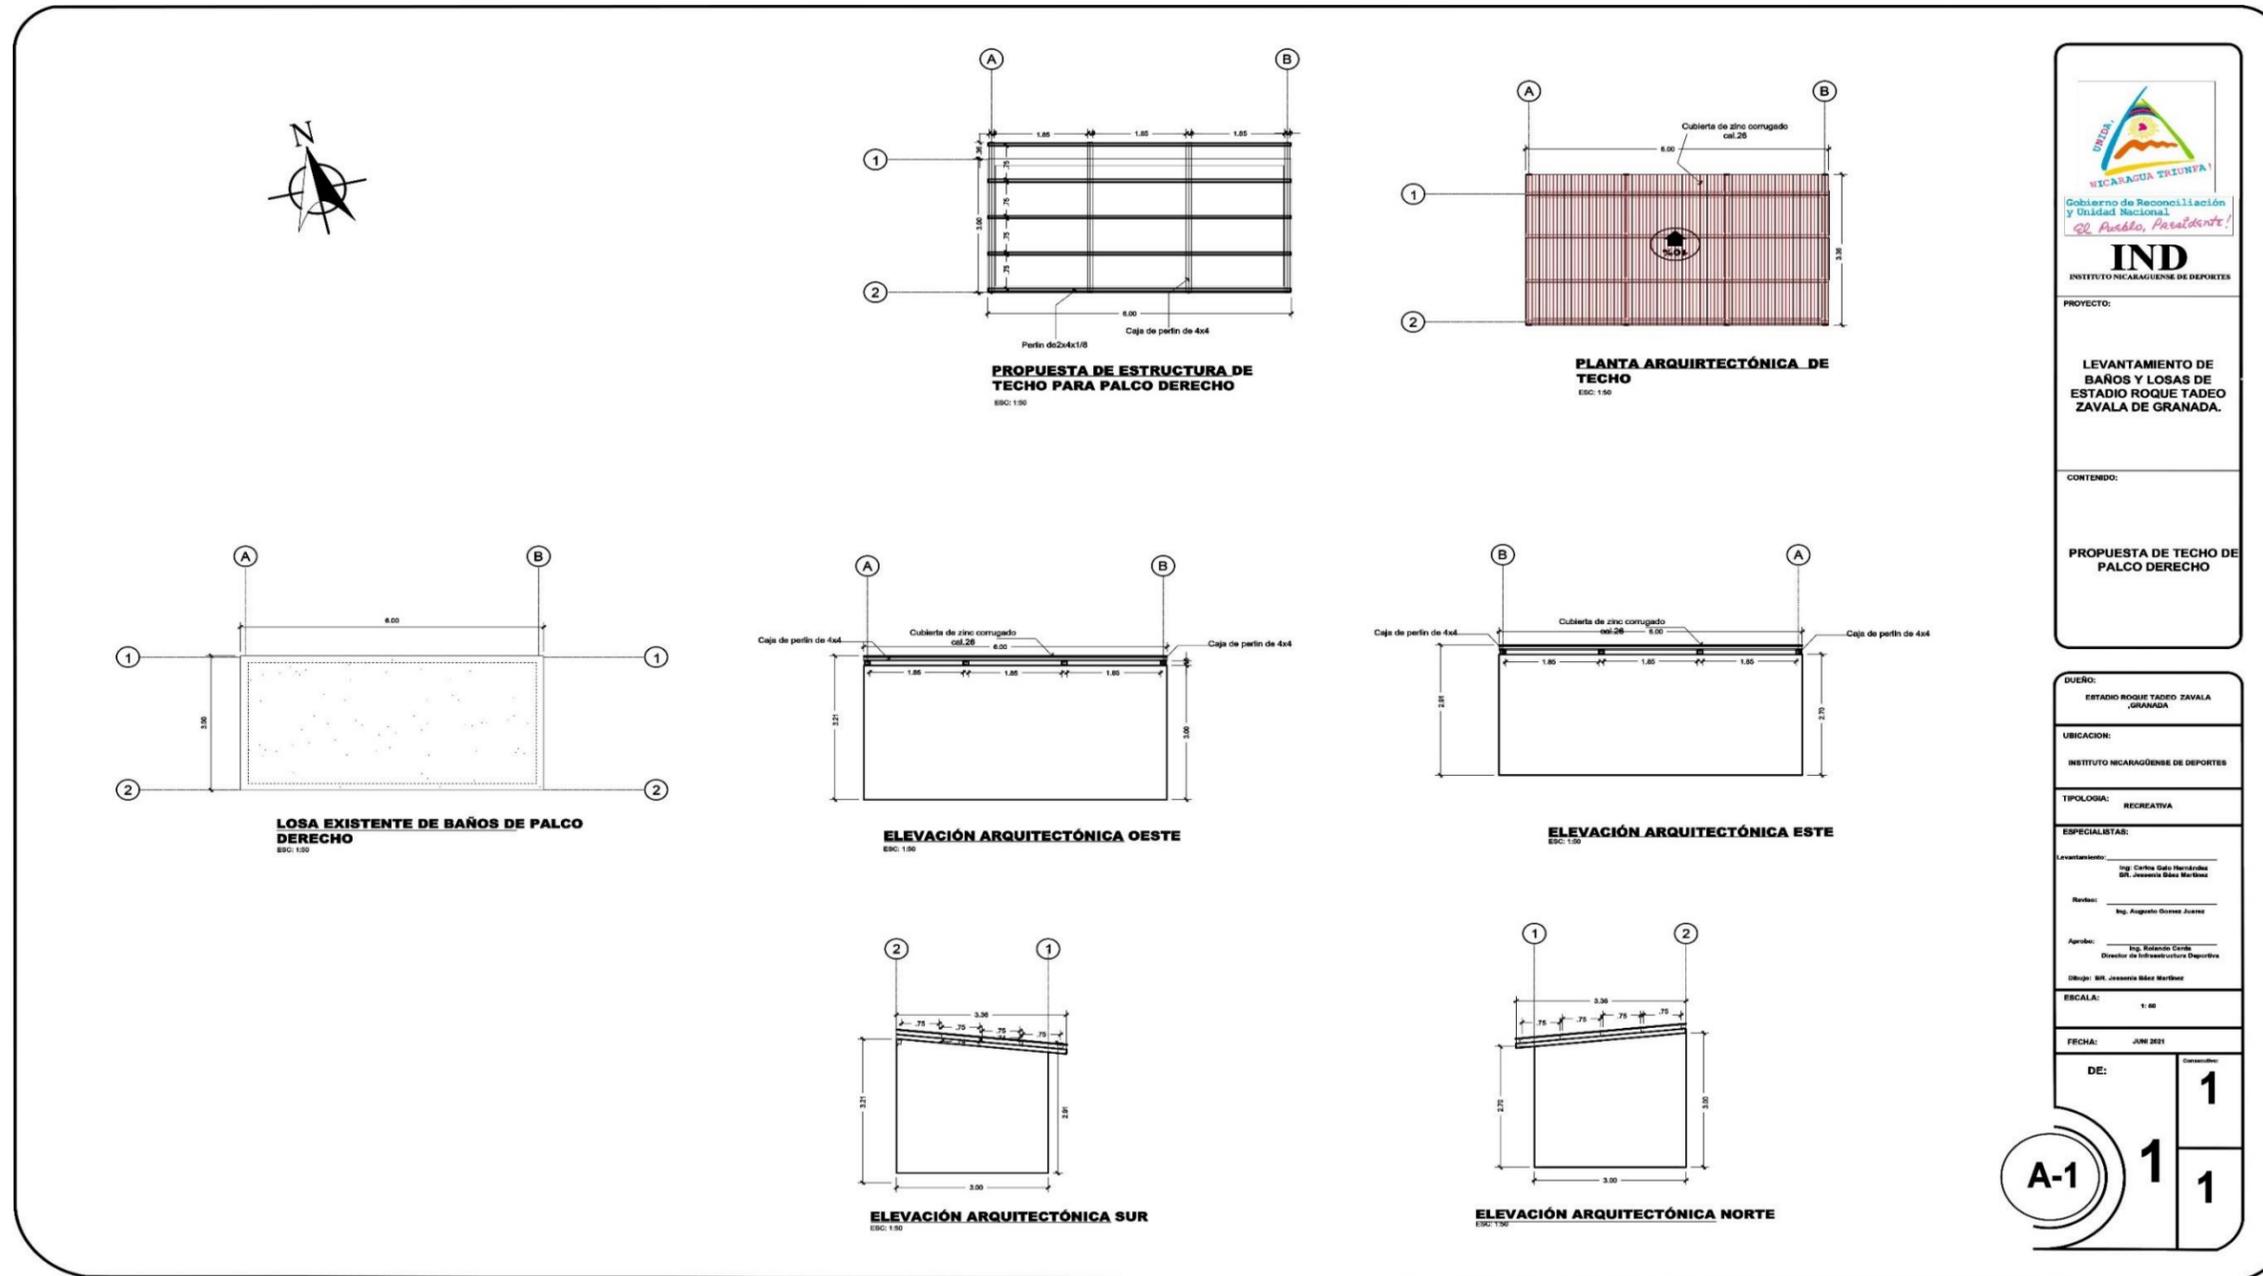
Propuesta de estructura de techo del área de palco derecho
